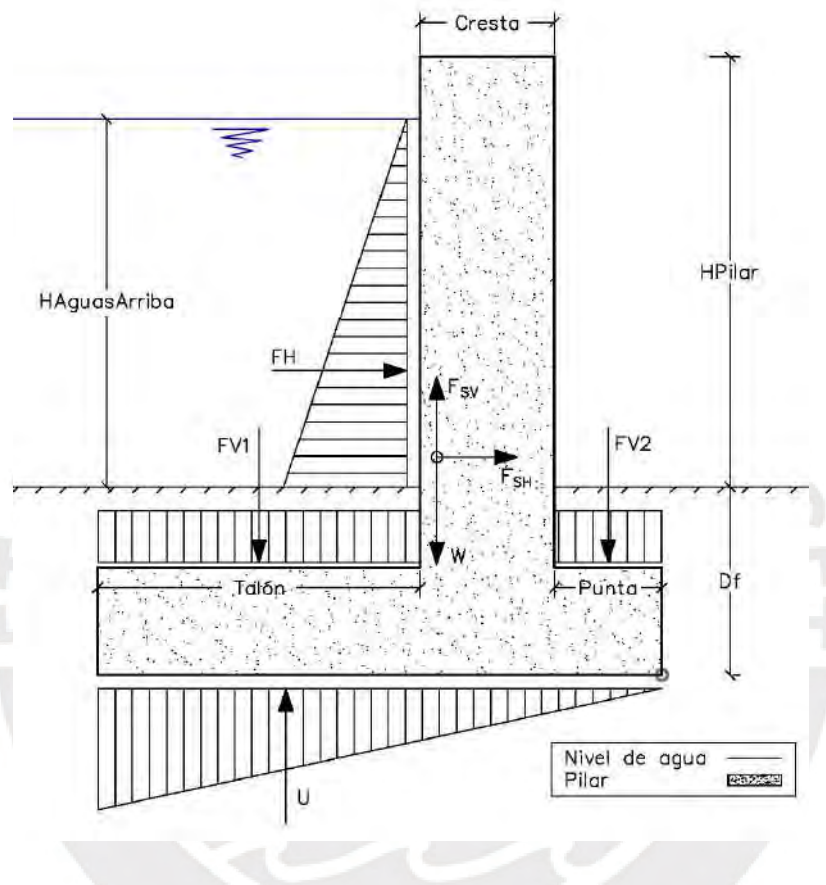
Fuerzas actuantes sobre pilar. Fuente: Elaboración propia.
